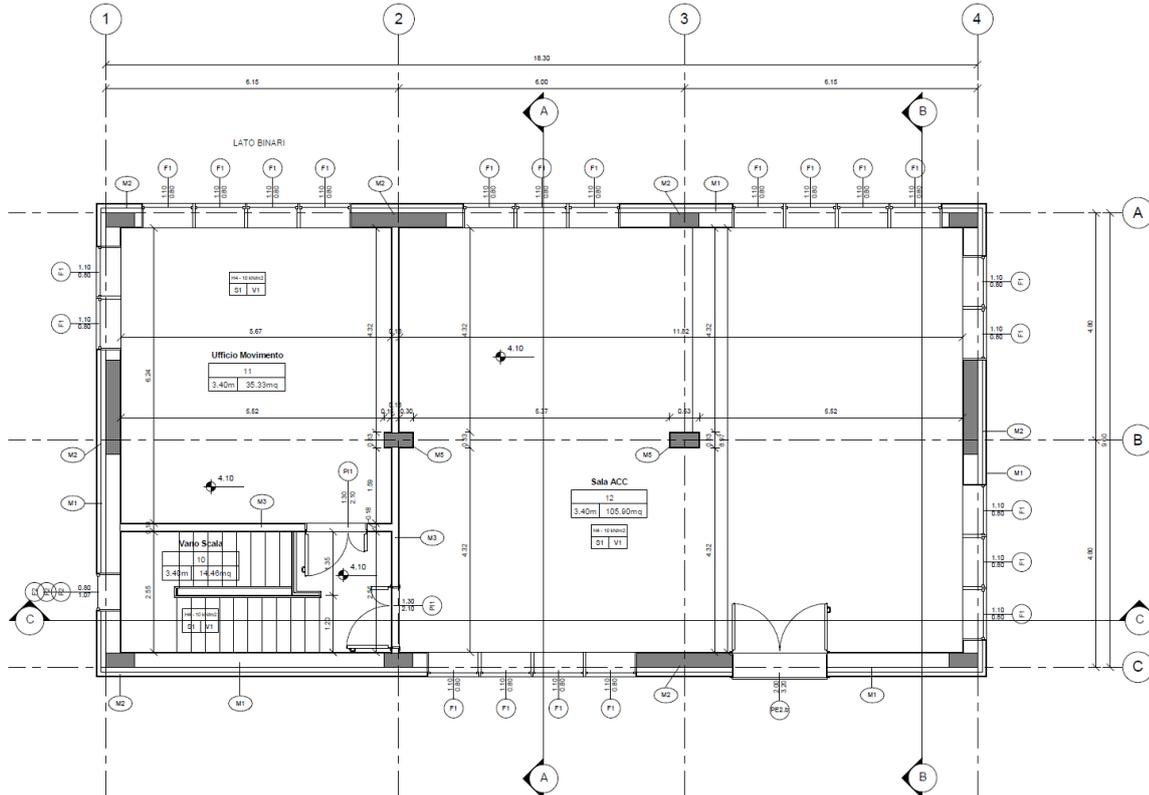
PPM Pieve Emanuele – Pianta Architettonica Piano Primo
